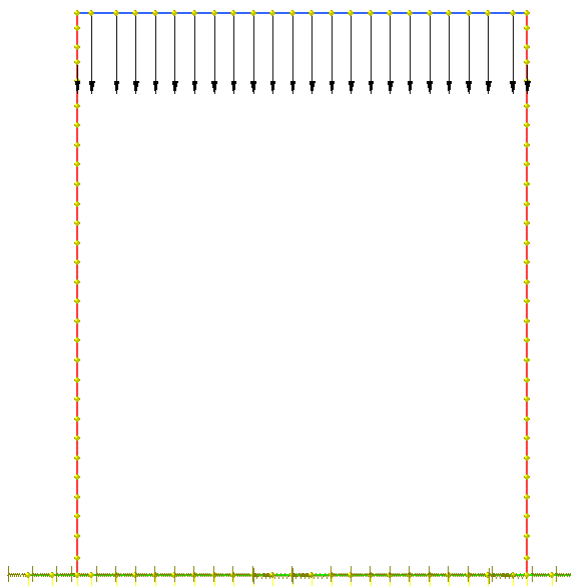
CARICHI PERMANENTI PAVIMENTAZIONE ESOTTOFONDO(CDC 2-3)
